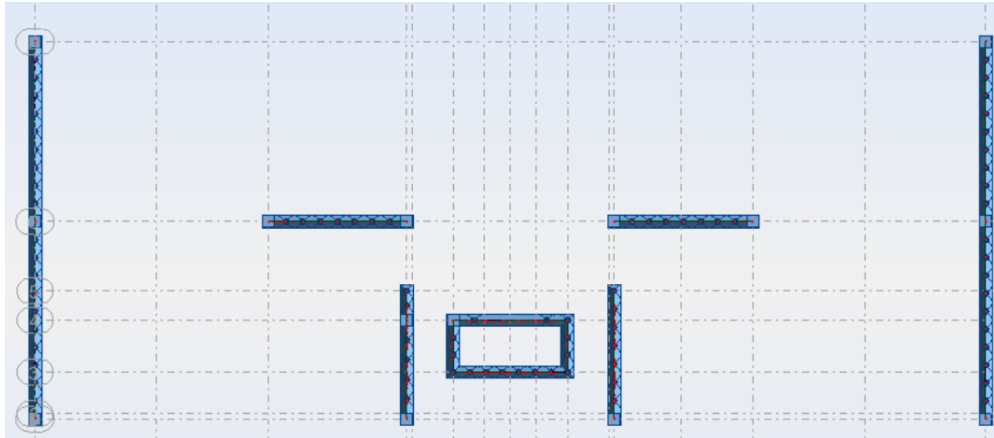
La 2^{ème} disposition des murs voiles et poteaux
